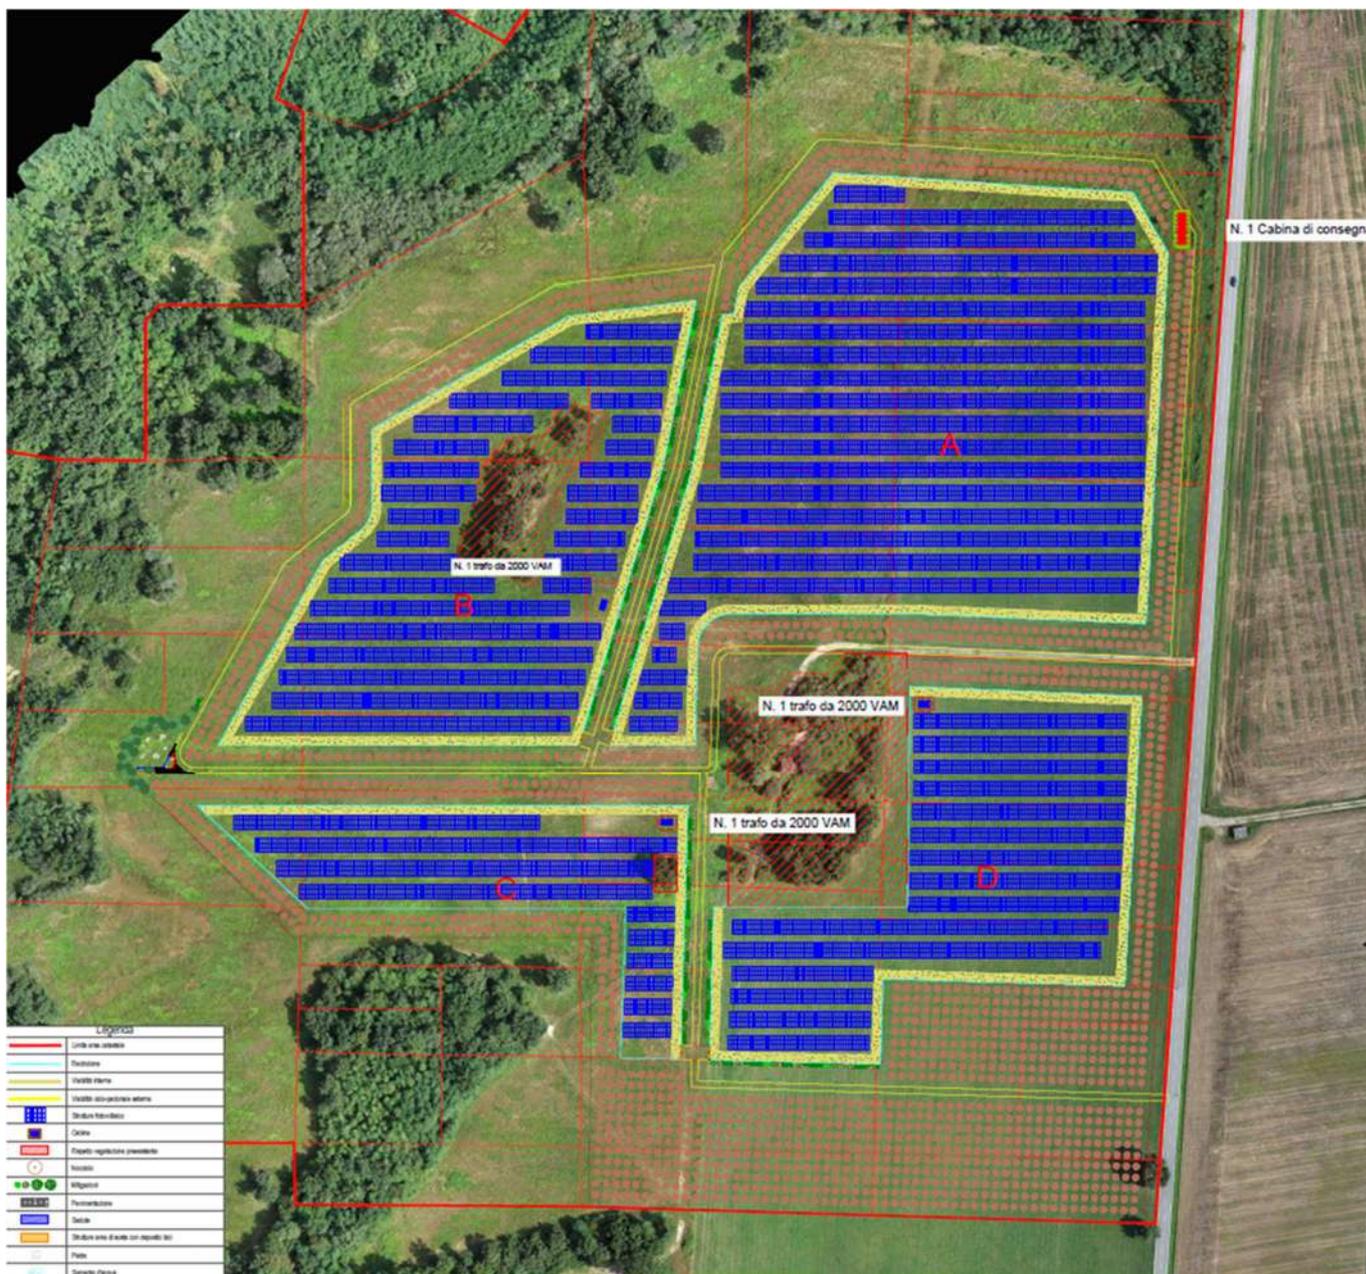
Layout di impianto. Tratto da Relazione Tecnica, Verifica di Assoggettabilità a VIA
